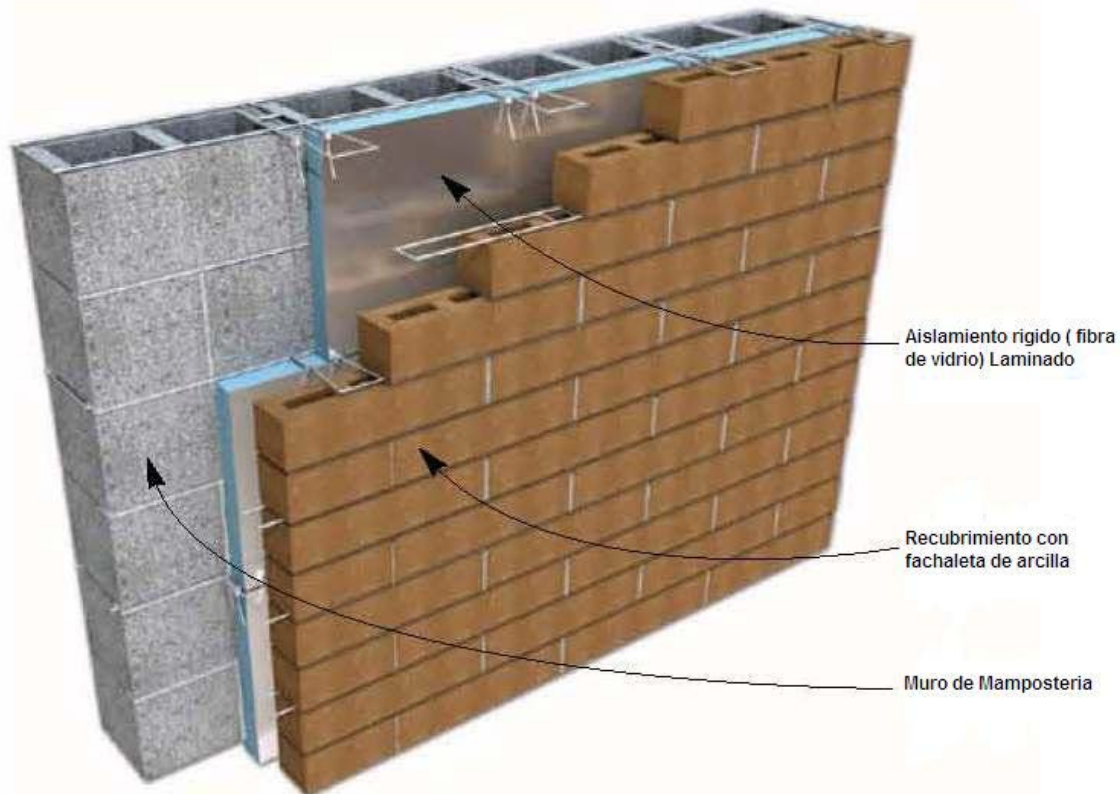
, configuración 3, aislamiento de muro de mampostería con capa de fibra aislante, y levantado de Fachaleta de arcilla, tomado de NCMA, thermal catalog of concrete masonry assamblies
